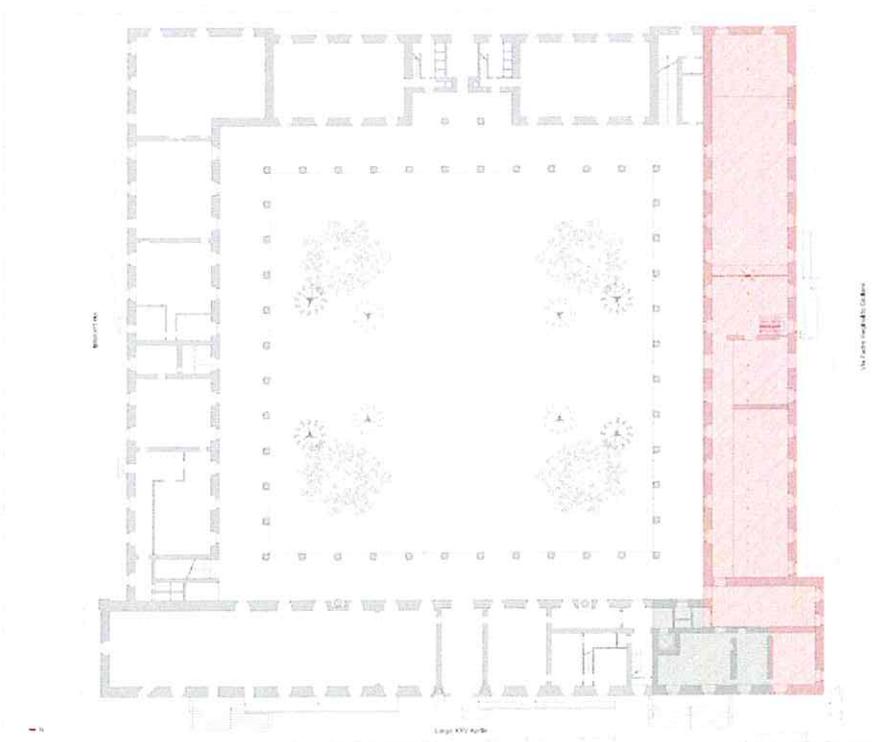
\_Planimetria piano terra della Biblioteca Civica
